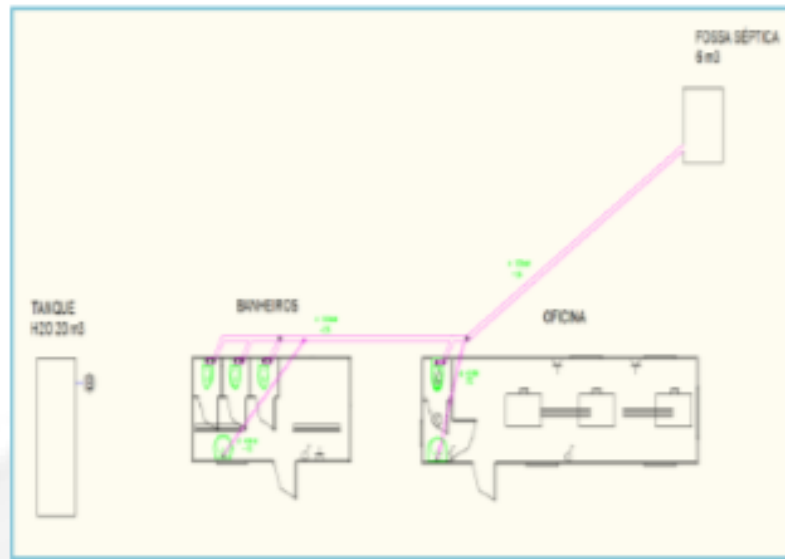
Estruturas do canteiro de obras. Fonte: RCA do empreendimento.
